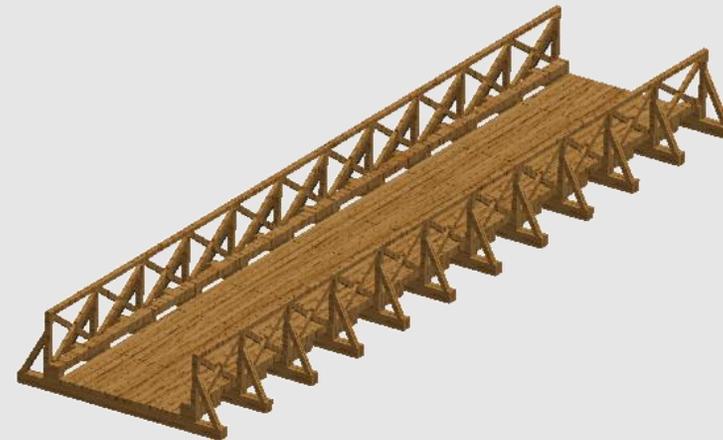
Vista isométrica tablero para pasarela peatonal sobre vigas metálicas- ancho de calzada 2,4 m.
